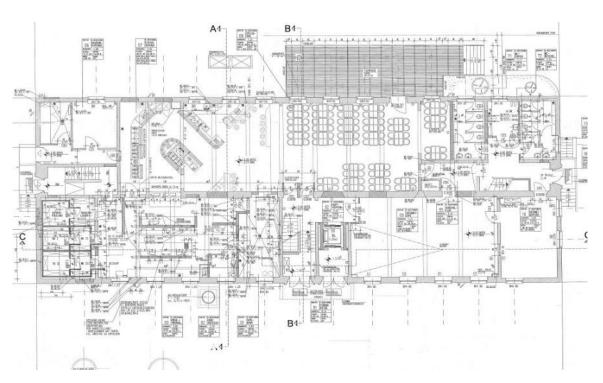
Grundrissplan Erdgeschoss, Gebäude FME
